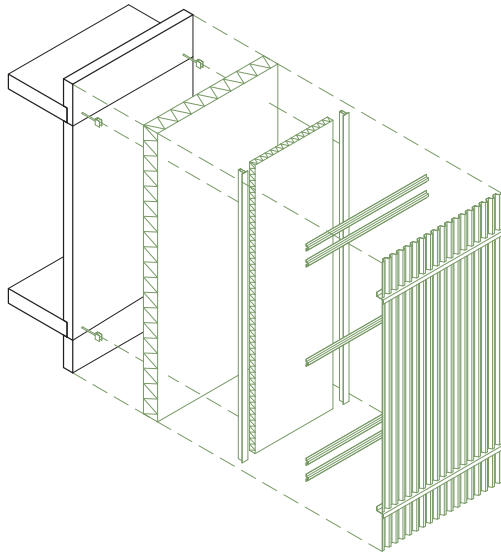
Konstruktionsprinzip für die Trapezblechfassade
